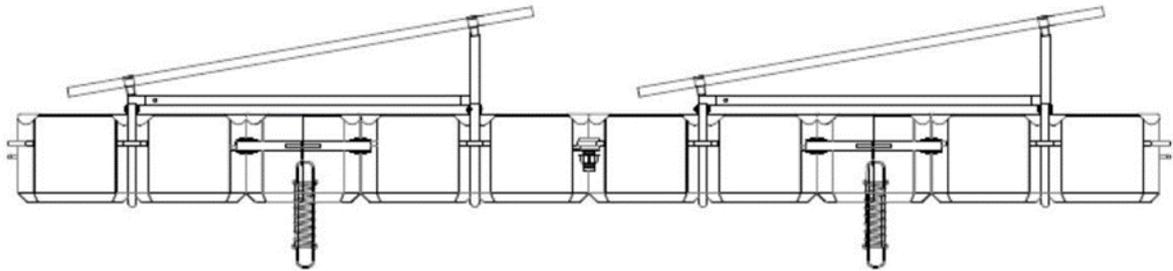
Dettaglio trasversale galleggianti dell'impianto flottante
